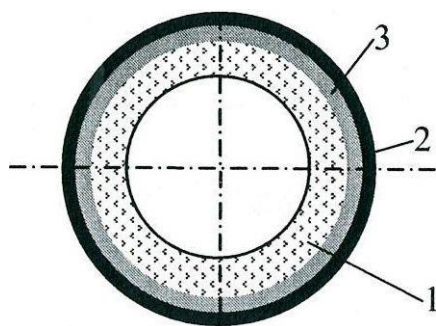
Конструкция изоляции: 1 – тепловая изоляция; 2 – гидроизоляция; 3 – покровный слой
